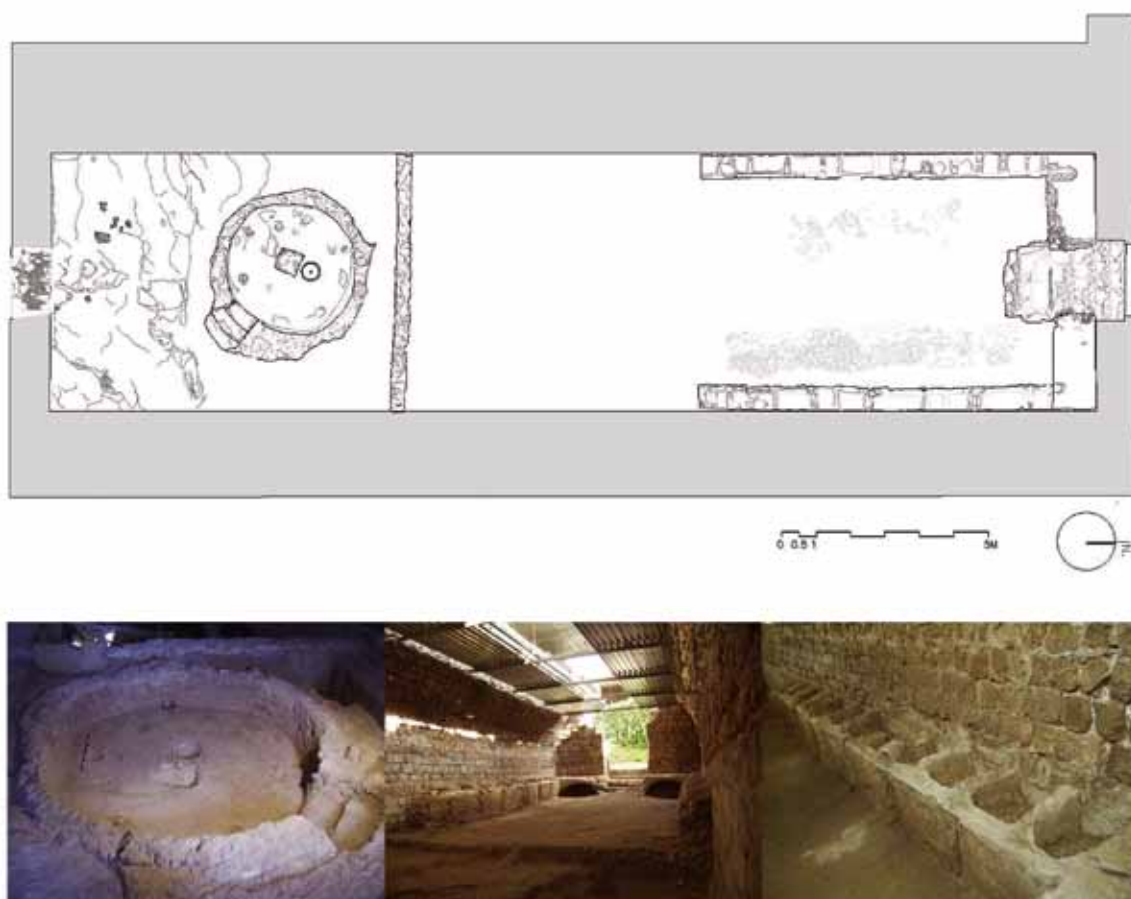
Planta general de la nau de les cavallerisses en època Sant Joanista. Vista de la premsa i de les menjadores. (Arxiu: CODEX – S.C.C.I.)
